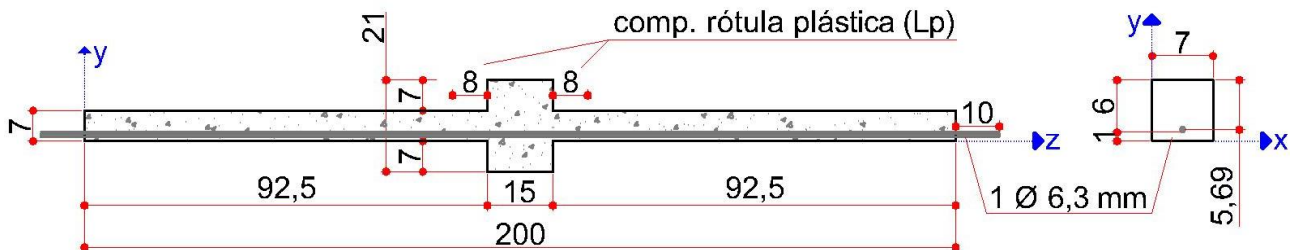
Detalhamento da seção longitudinal e transversal das vigas e da armadura empregada.
